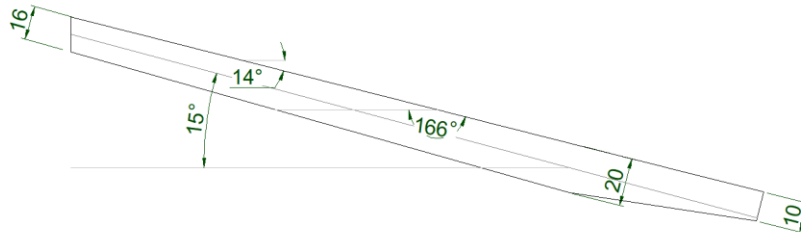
Detalhe da seção transversal na peça da viga. (Dimensões em cm)
